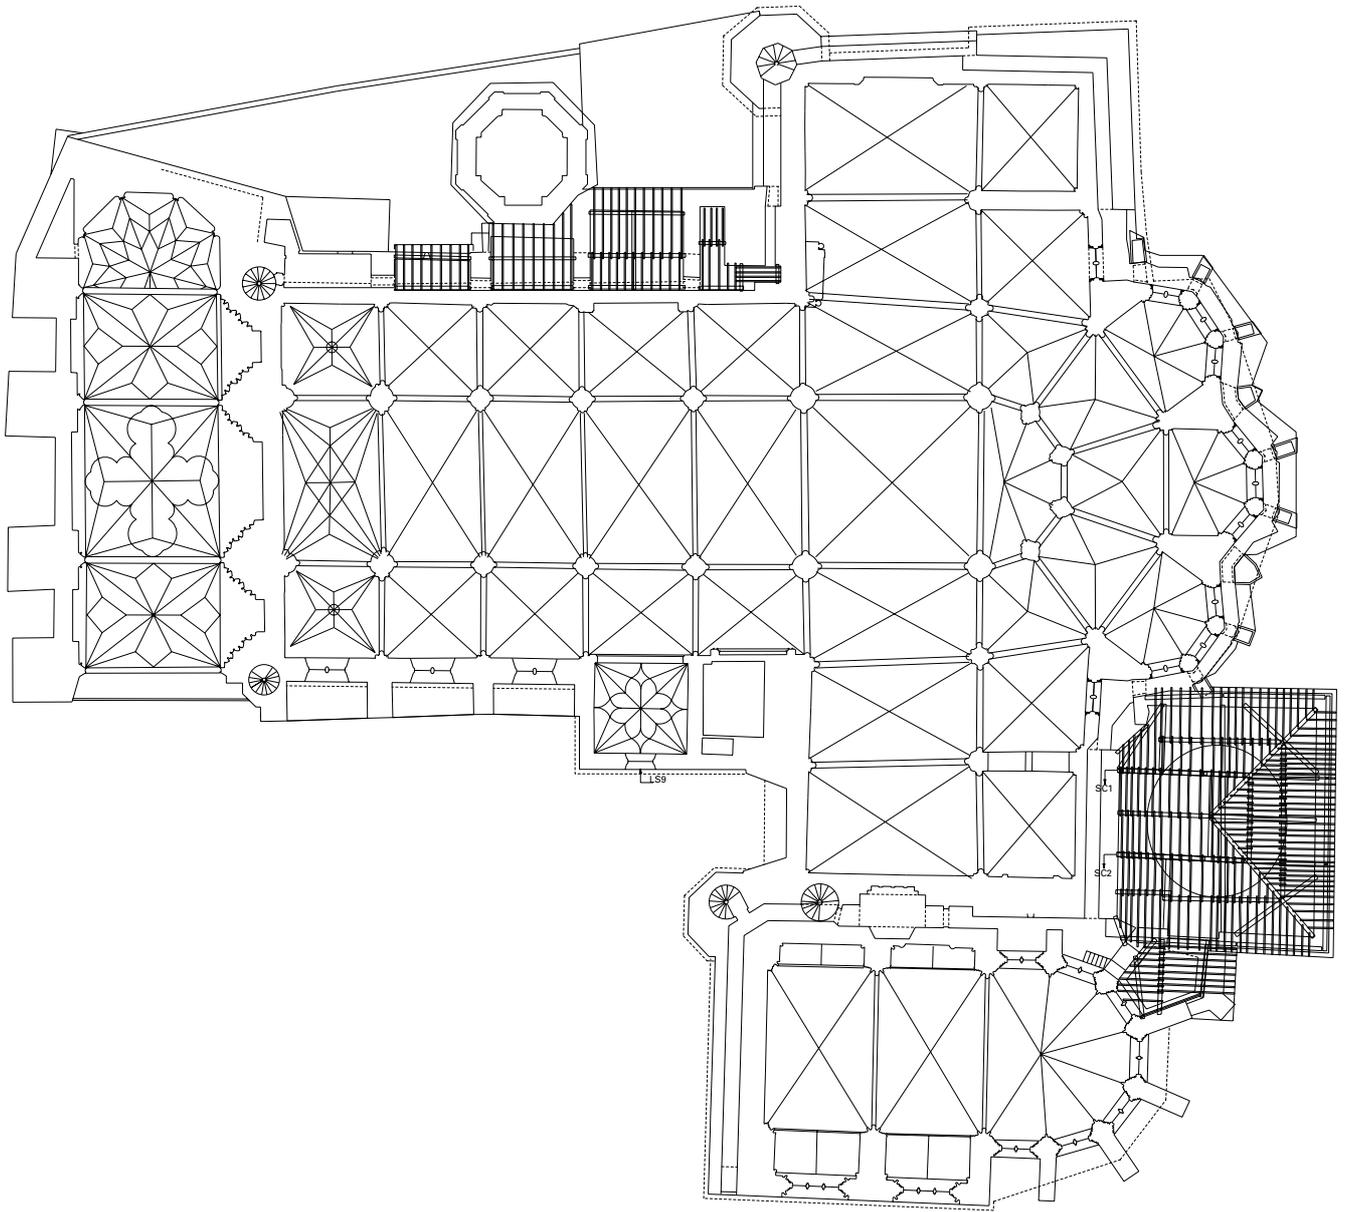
Estructuras de cubierta: paso de ronda y sacristía
